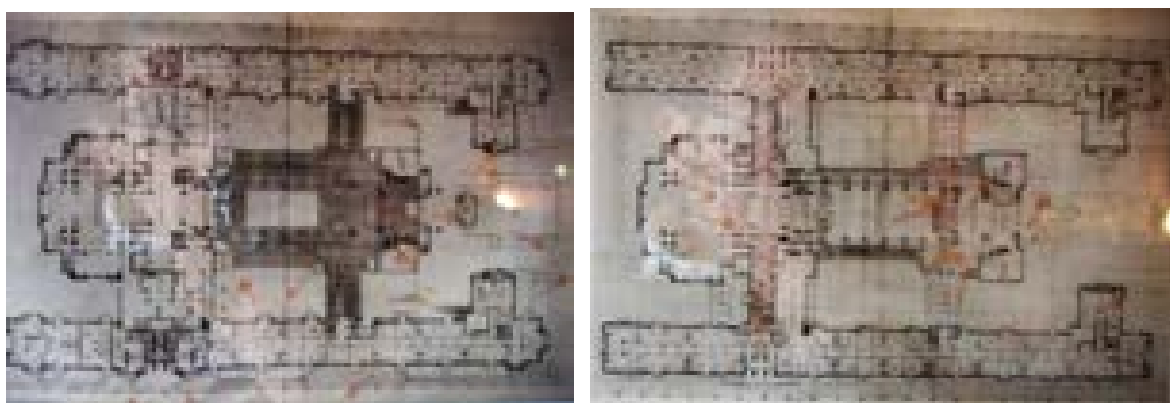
le planimetrie dell'Imperial Hotel con indicati gli elementi di arredo recuperati(Foto Andrea Masi)
